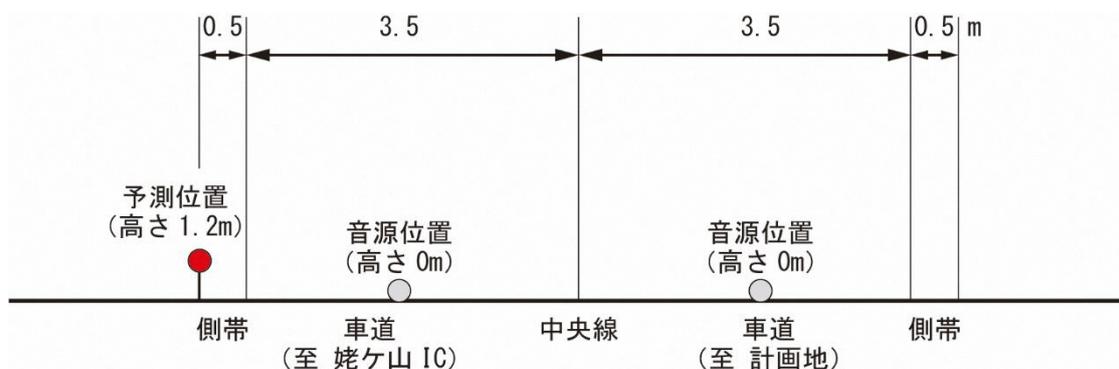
(2) 道路断面図 (No.2 : 嘉瀬蔵岡線沿道 (西側))
